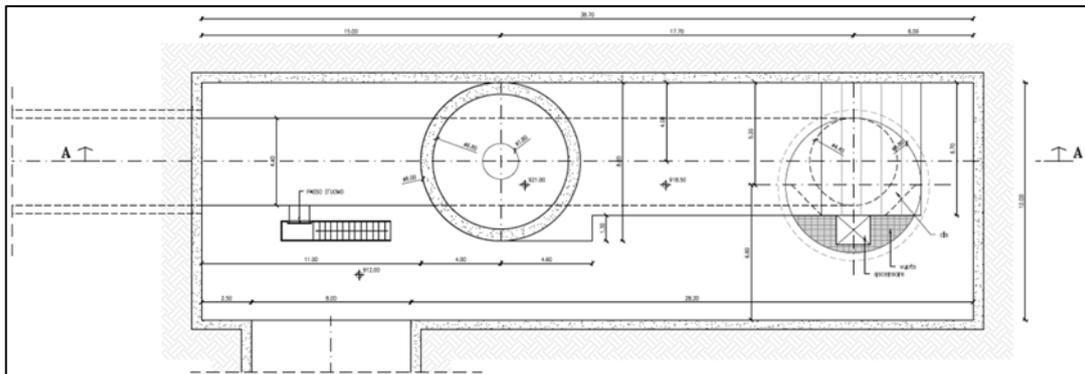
Pianta del pozzo piezometrico e della caverna alla sua base
